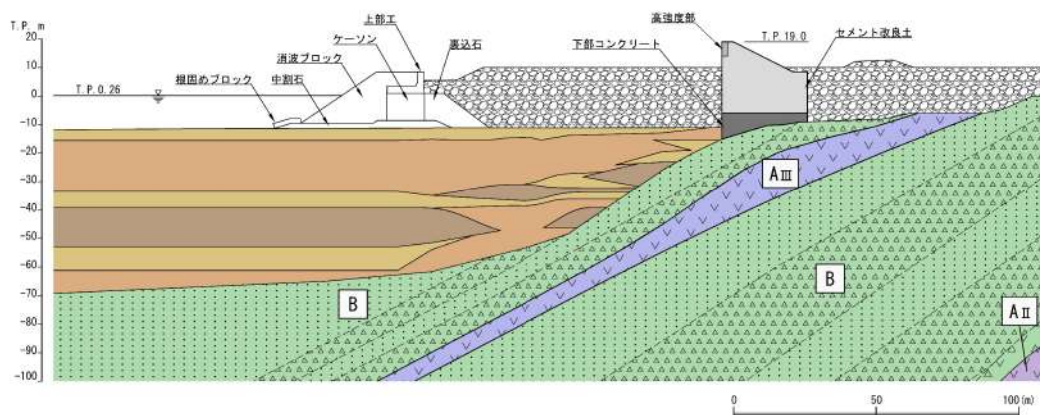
c.b-10 地質断面図 (B-B' 断面)
